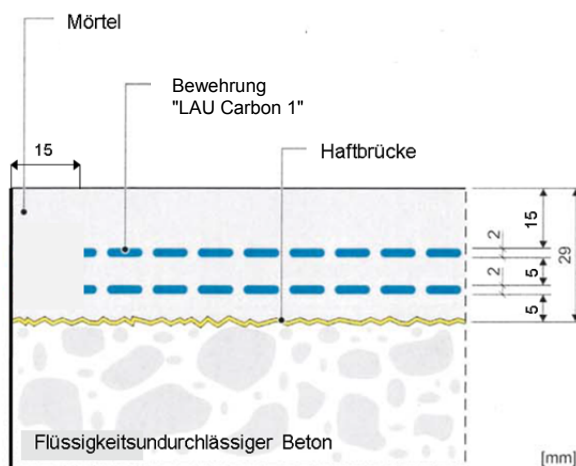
Beispielhafter Einbau des Carbonbetonsystems für eine Flüssigkeit mit  $e_{tk} = 13$  mm mit zwei Lagen textiler Bewehrung
